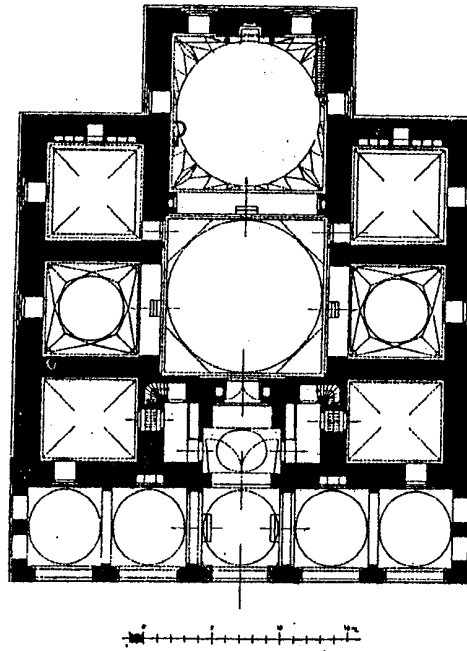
مسقط أفقي لجامع محب الدين أبو الطيب بالقاهرة .
